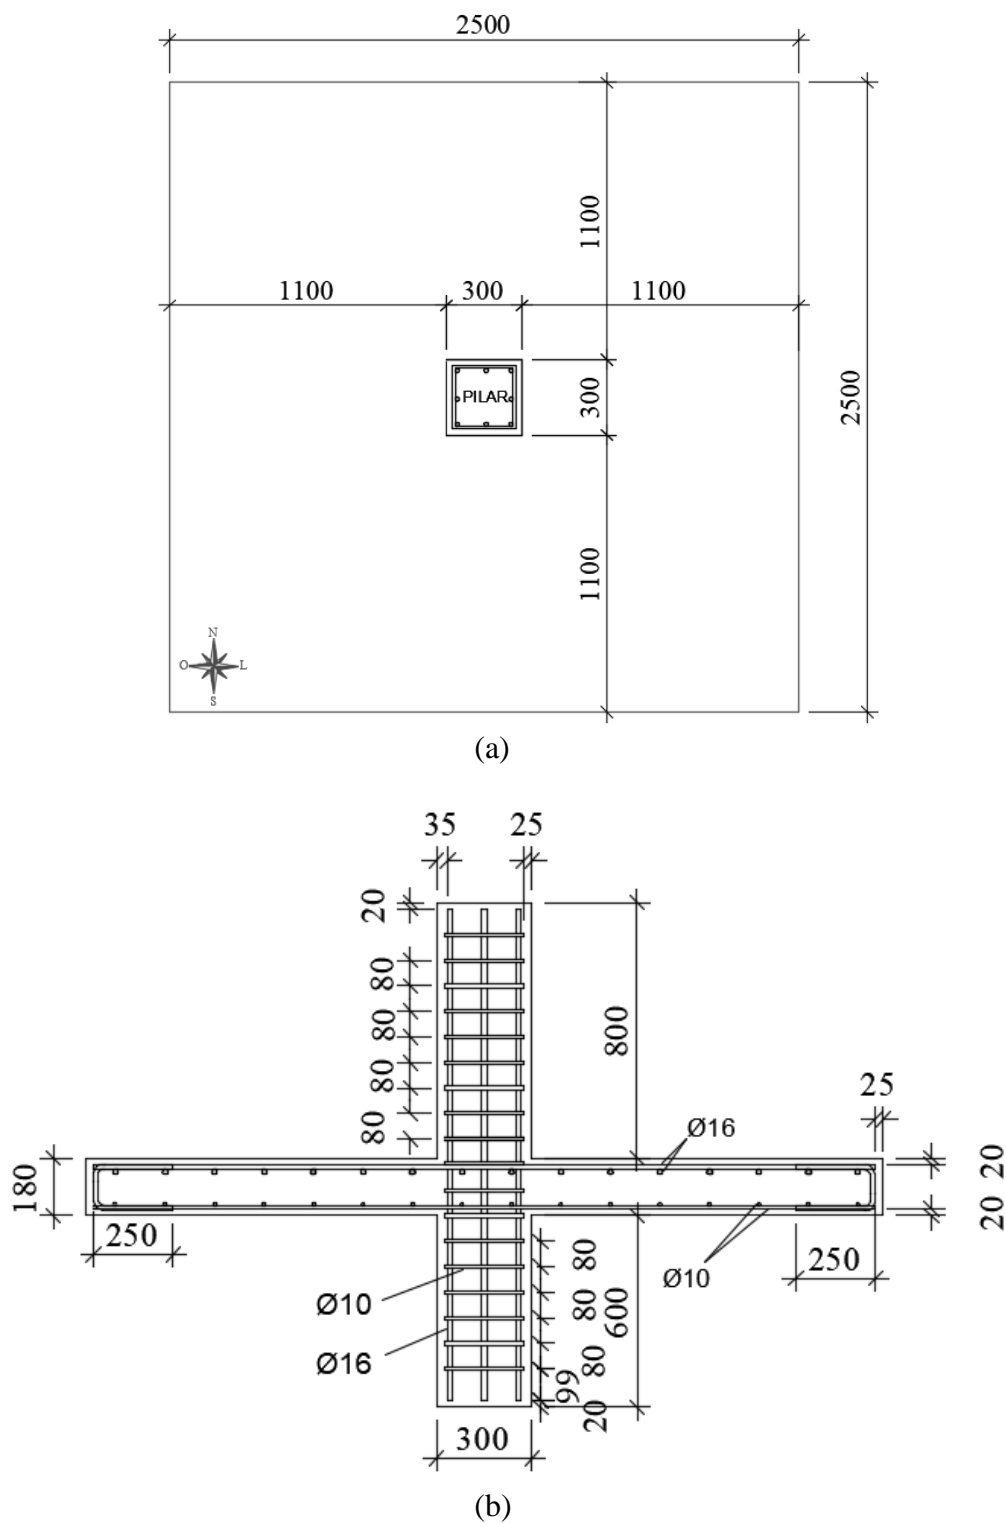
(a) Representação de uma vista da laje em estudo; b) Representação esquemática da ligação laje pilar das lajes em estudo (dimensões dadas em milímetros)
